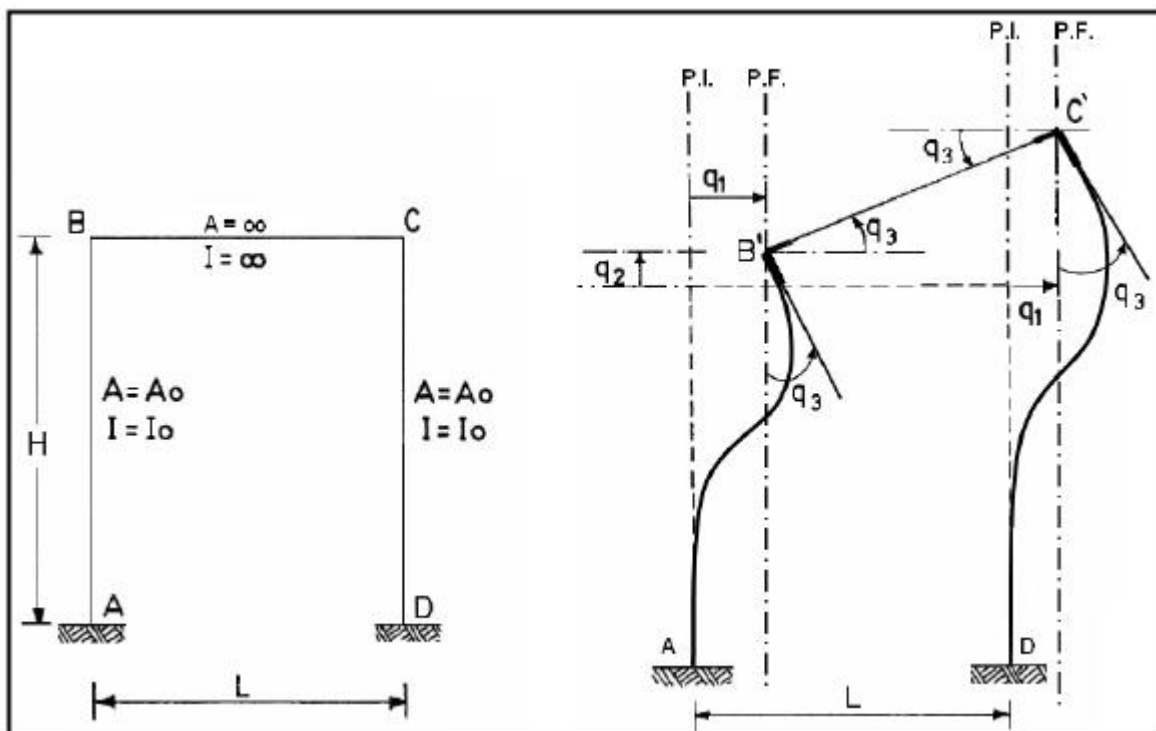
Pórtico con viga totalmente rígida y deformada general.
